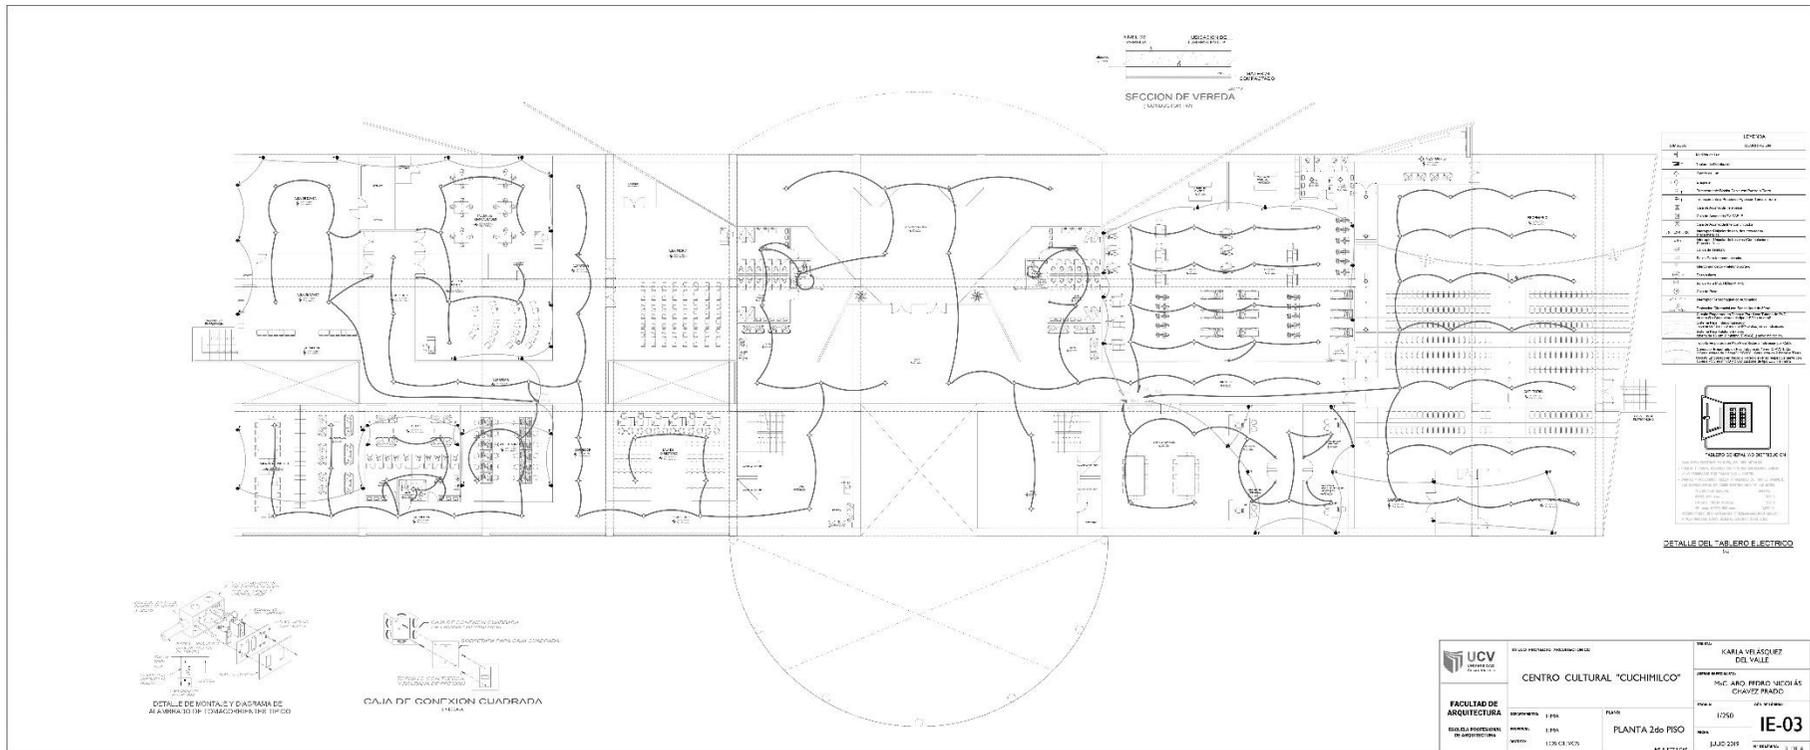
Plano Eléctrico Planta 2do Piso. Elaboración propia
